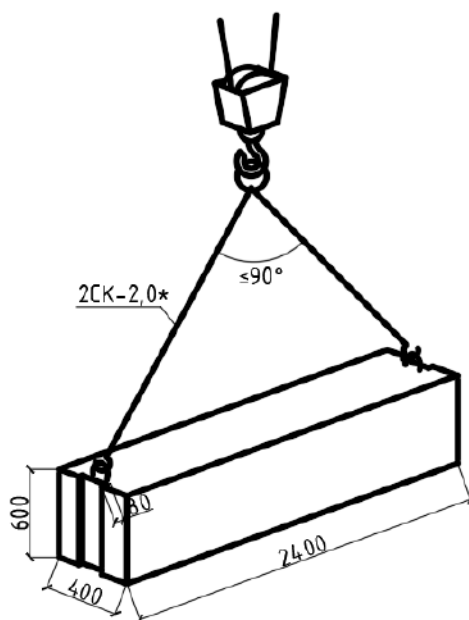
Схема строповки фундаментных стеновых фундаментных блоков
